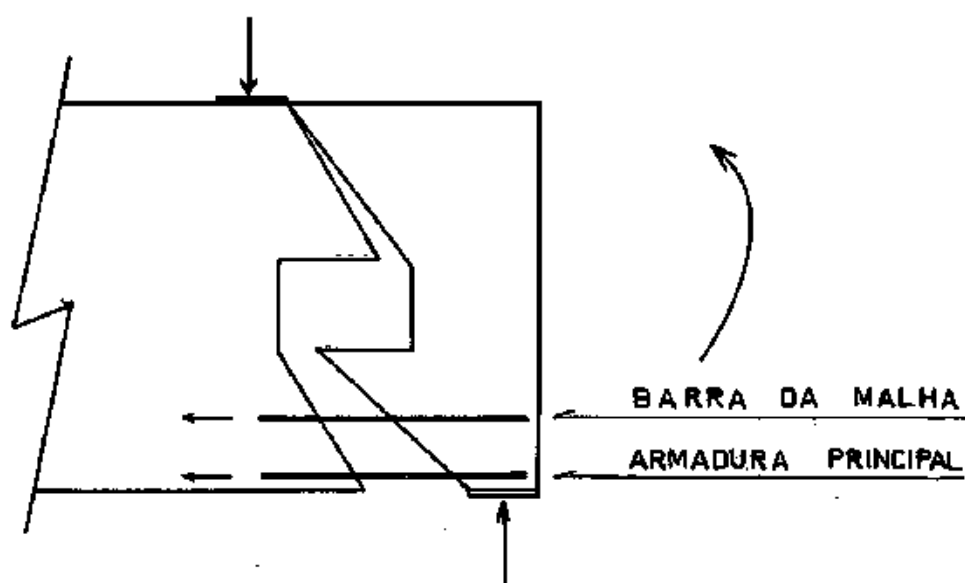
Mecanismo de rotação de uma viga parede com furos
